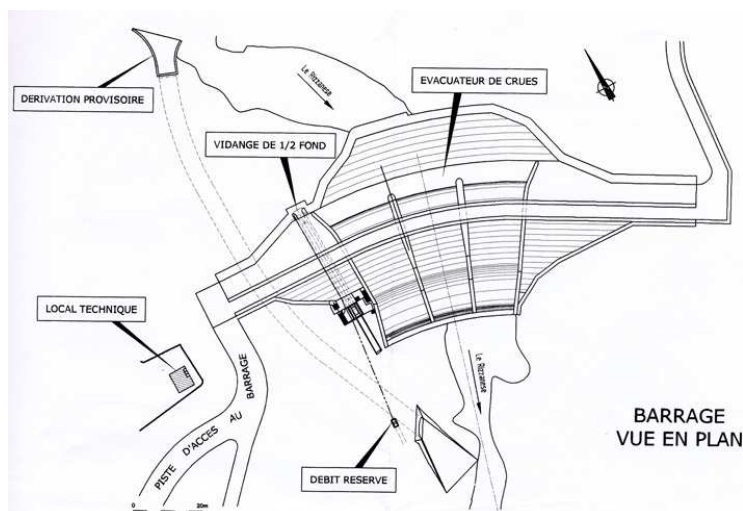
Vista em Planta da Barragem de Rizzanese - [36].
